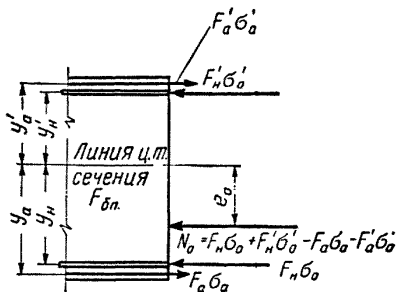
Схема распределения усилий в арматуре предварительно напряженного элемента
